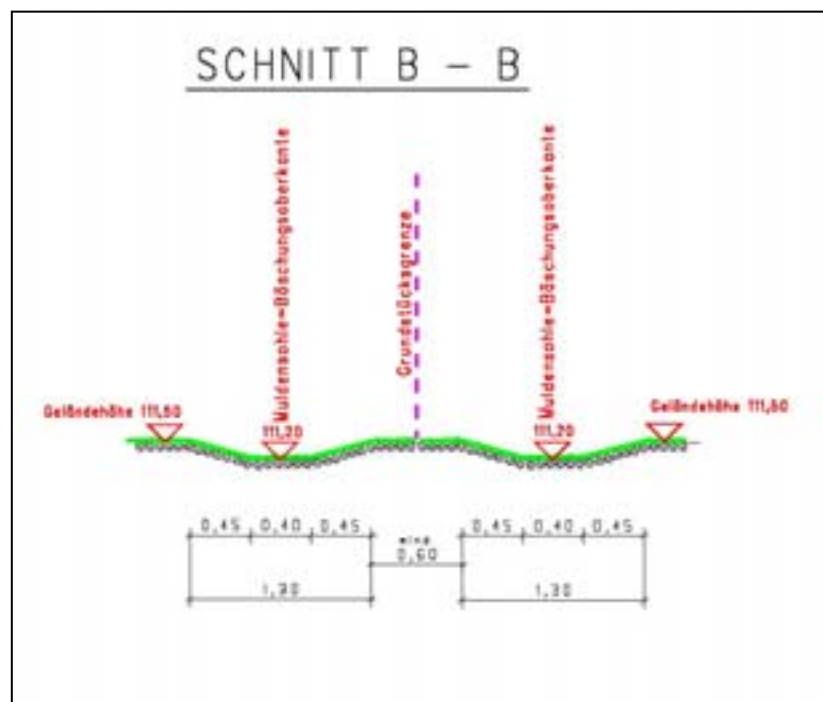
geplante Ableitung des Niederschlagswassers, Geländeschnitt B-B
